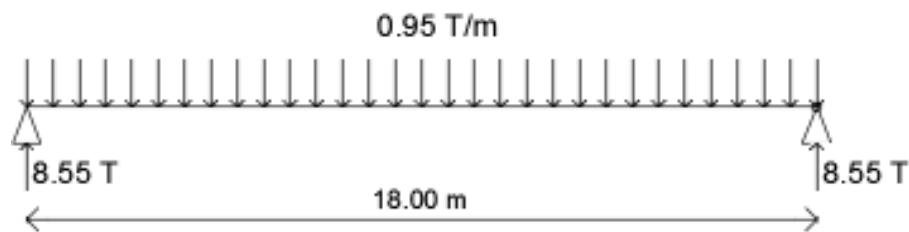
Cálculo de reacciones de camión por viga caso crítico para el estribo
